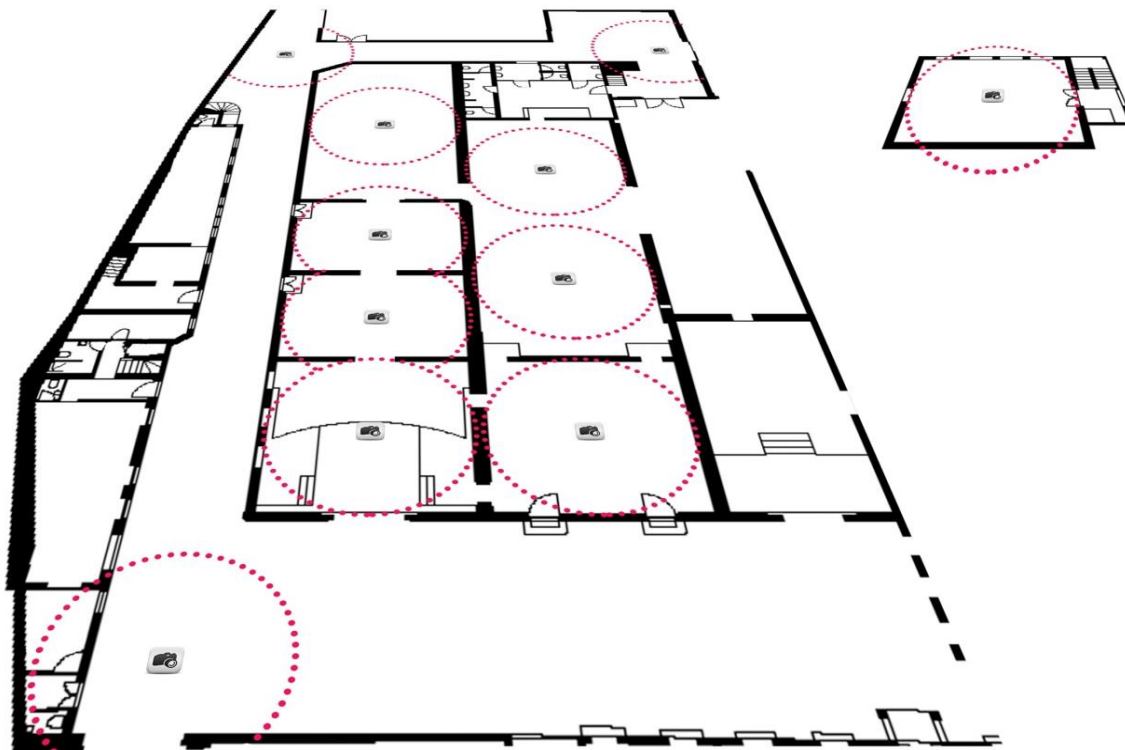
Planta da Fundação do Mestre José Rodrigues
